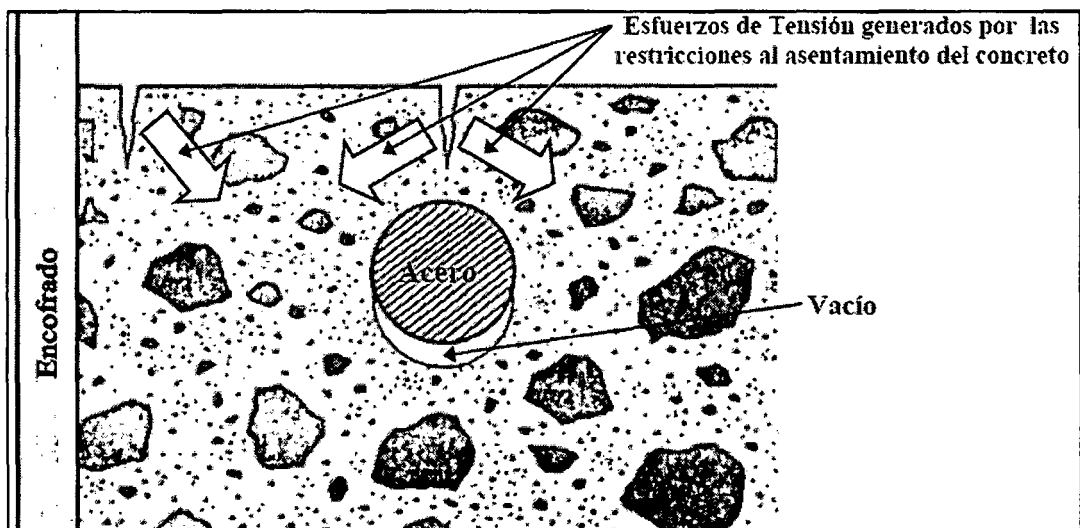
Fisura formada debido al asentamiento del concreto.
